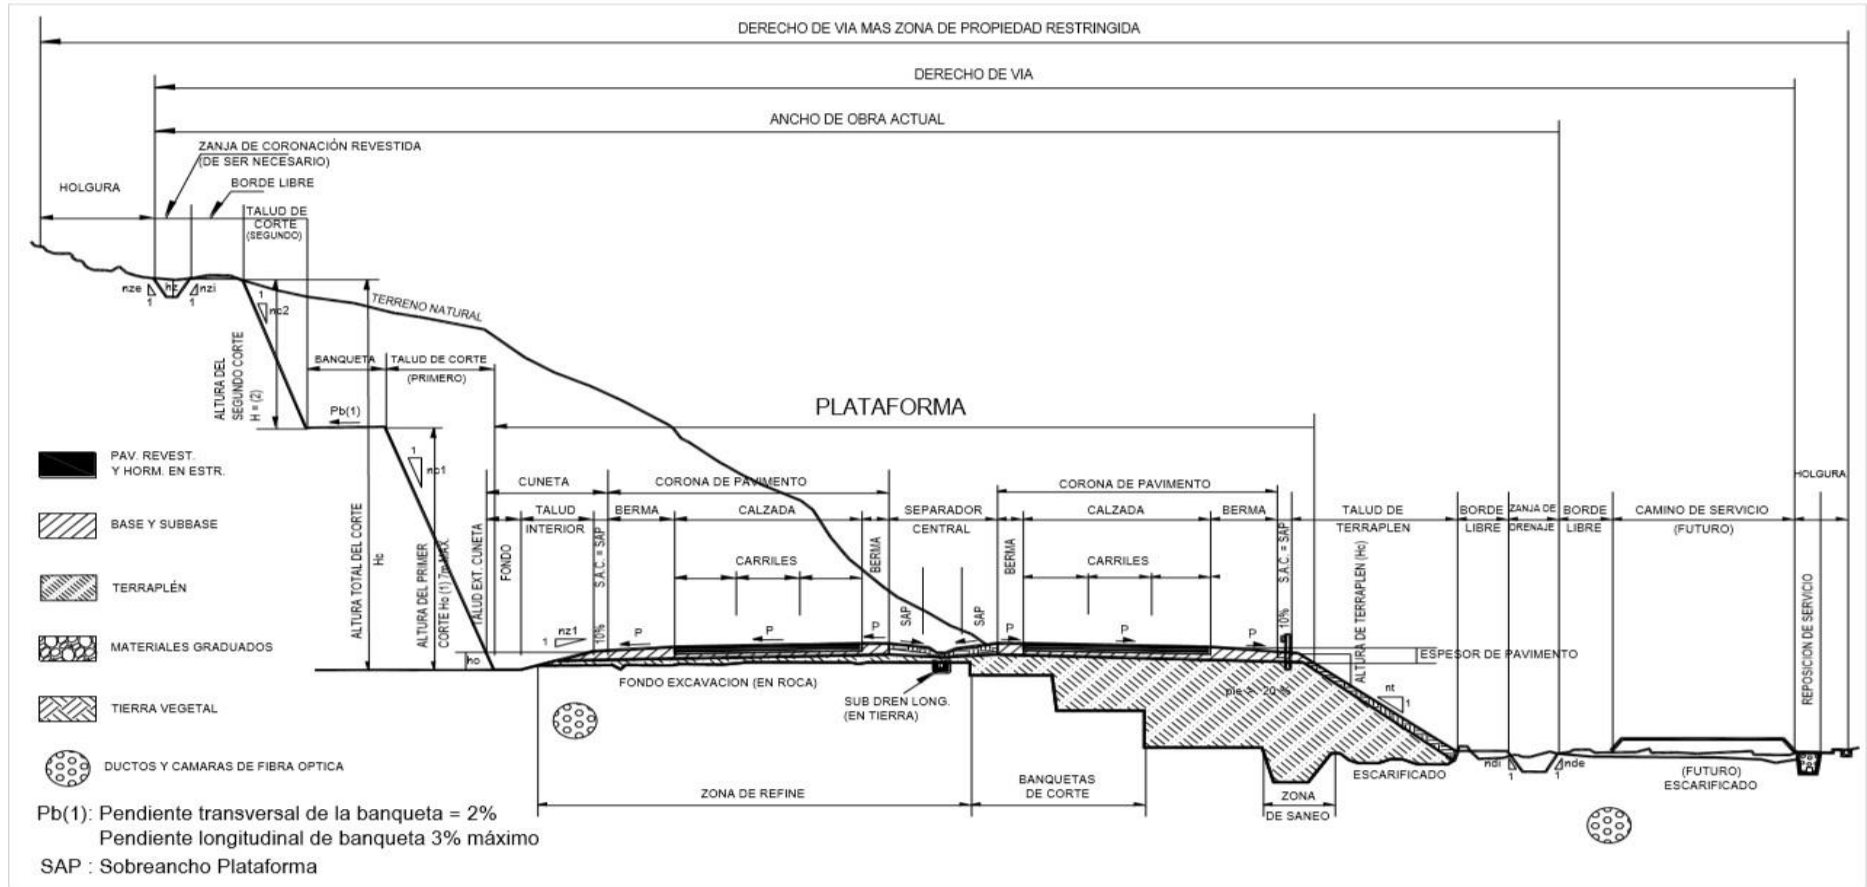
Sección transversal tipo a media ladera para una autopista en tangente.
